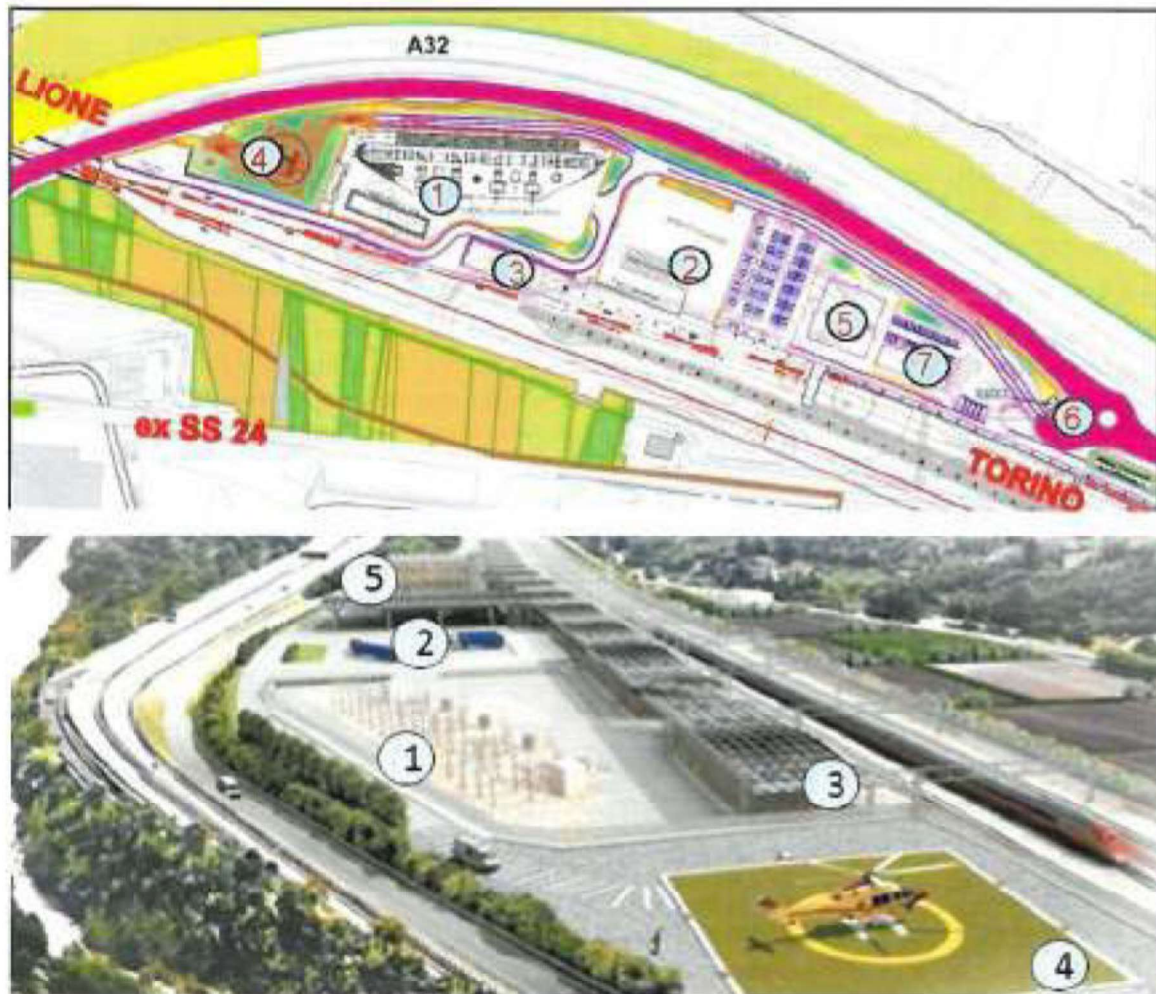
Schema planimetrico e render esemplificativo dell'area tecnica e di sicurezza
